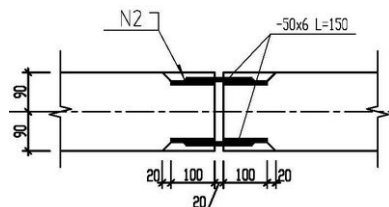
Конструкция расположения узловых пластин на боковых торцах при устройстве вертикального упругоподатливого узла наружных стеновых панелей
